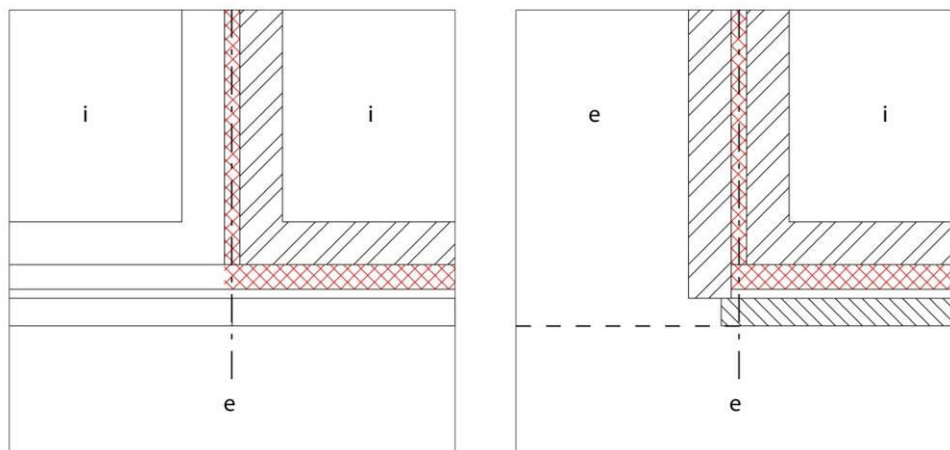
Là où une façade extérieure rejoint un mur qui se trouve sur la limite mitoyenne, il y a toujours un nœud constructif linéaire, même si le mur ne fait pas partie de la surface de déperdition : tant le mur intérieur (à gauche) que le mur extérieur (à droite) donne lieu à un nœud constructif linéaire.
